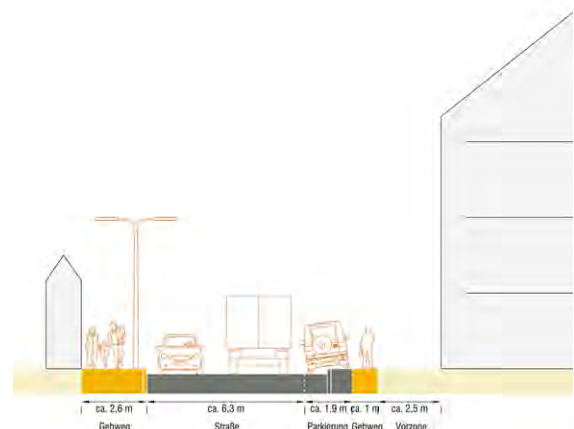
Straßenquerschnitt Hauptstraße Bestand
